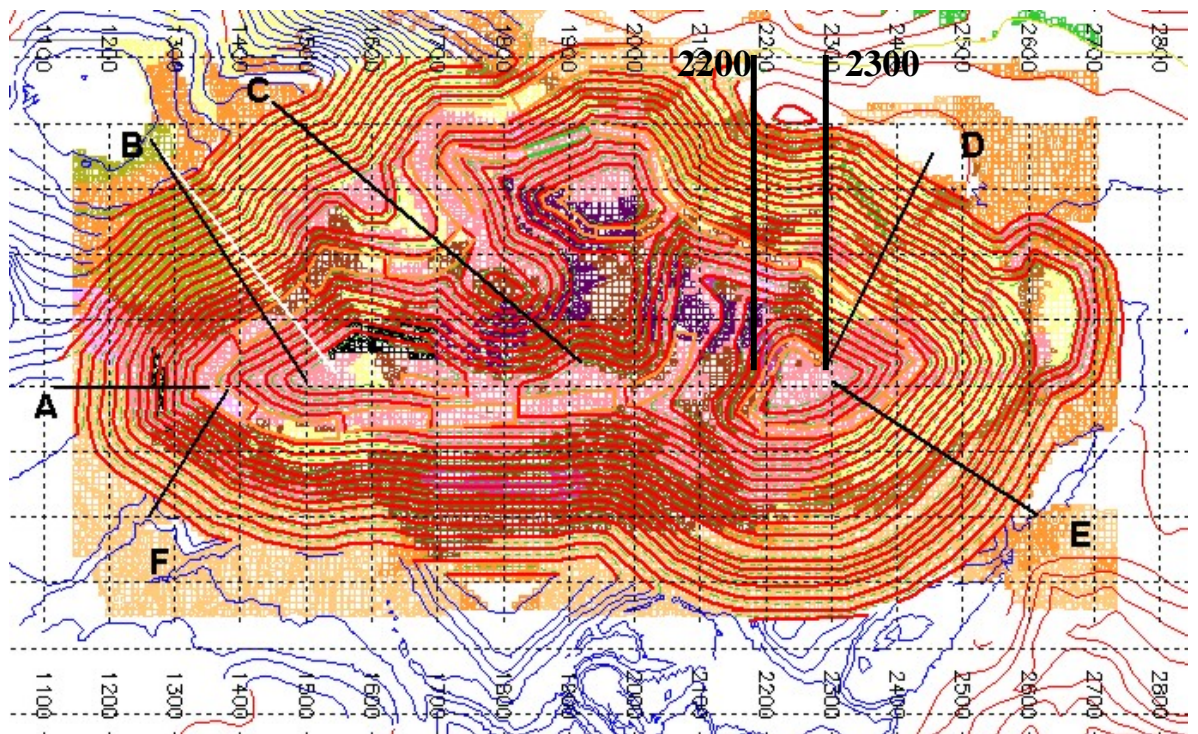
Planta Geológica da Mina do Capão Xavier.
